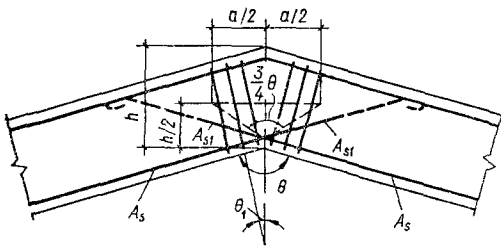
Армирование входящего угла, расположенного в растянутой зоне железобетонного элемента.
